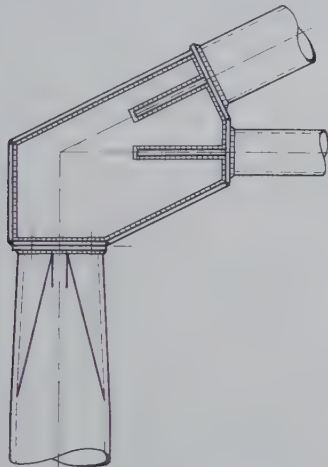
Vielflächenknoten. Stütze mit kreuzförmigem Kopf
